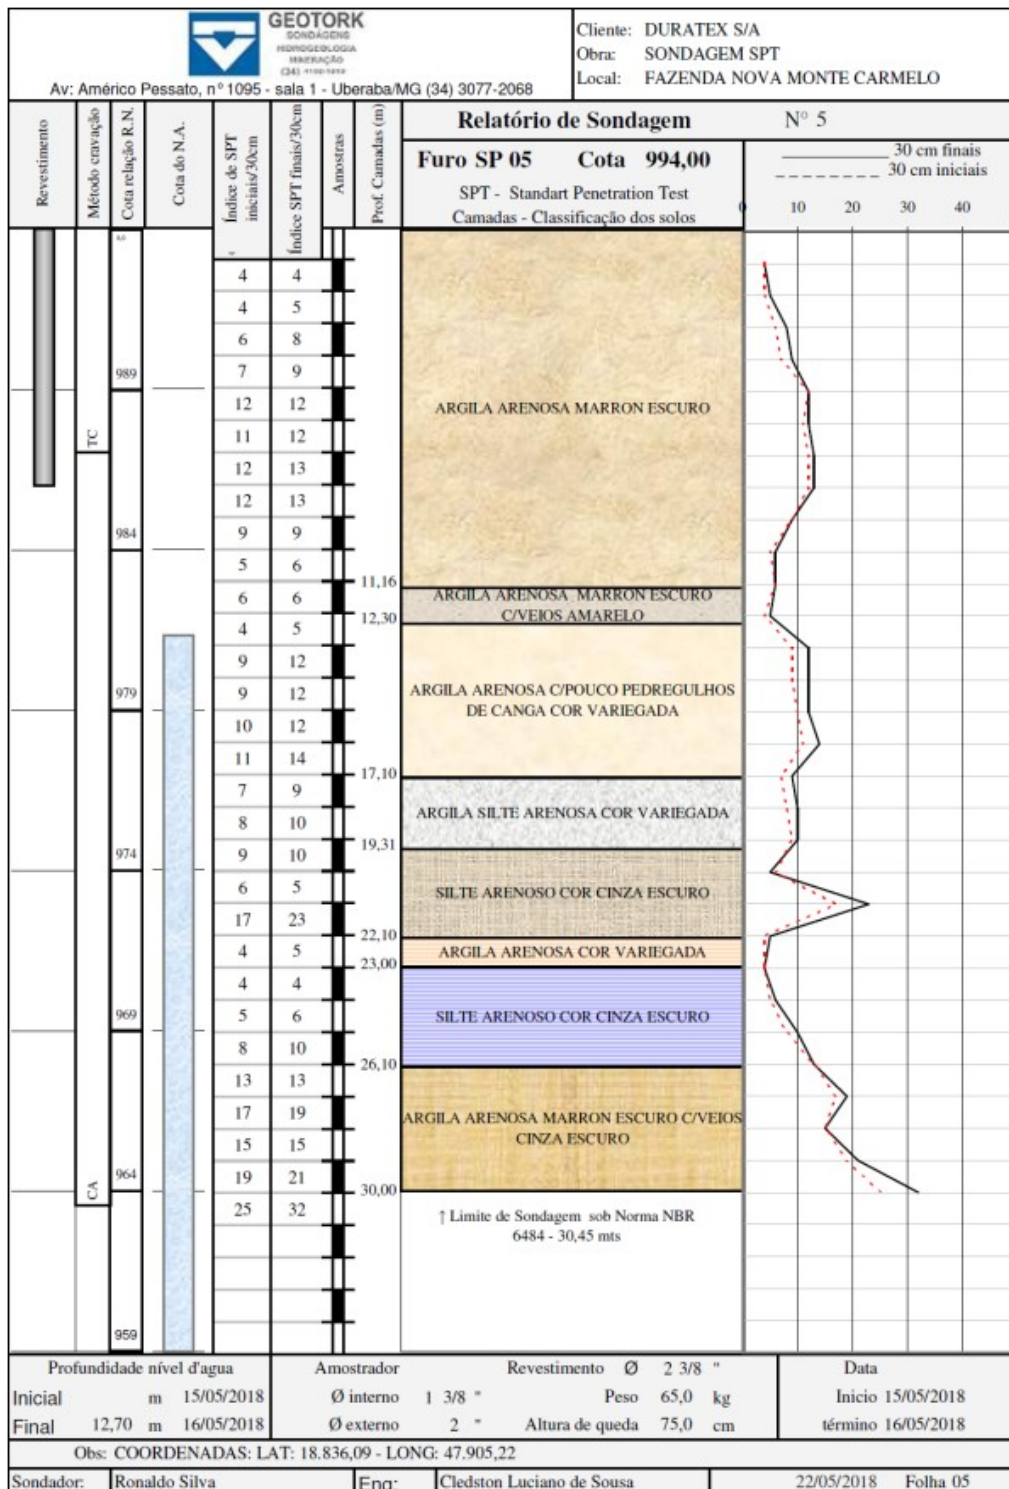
Perfil do furo de sondagem SP05. Fonte: GEOTORK, 2018.
